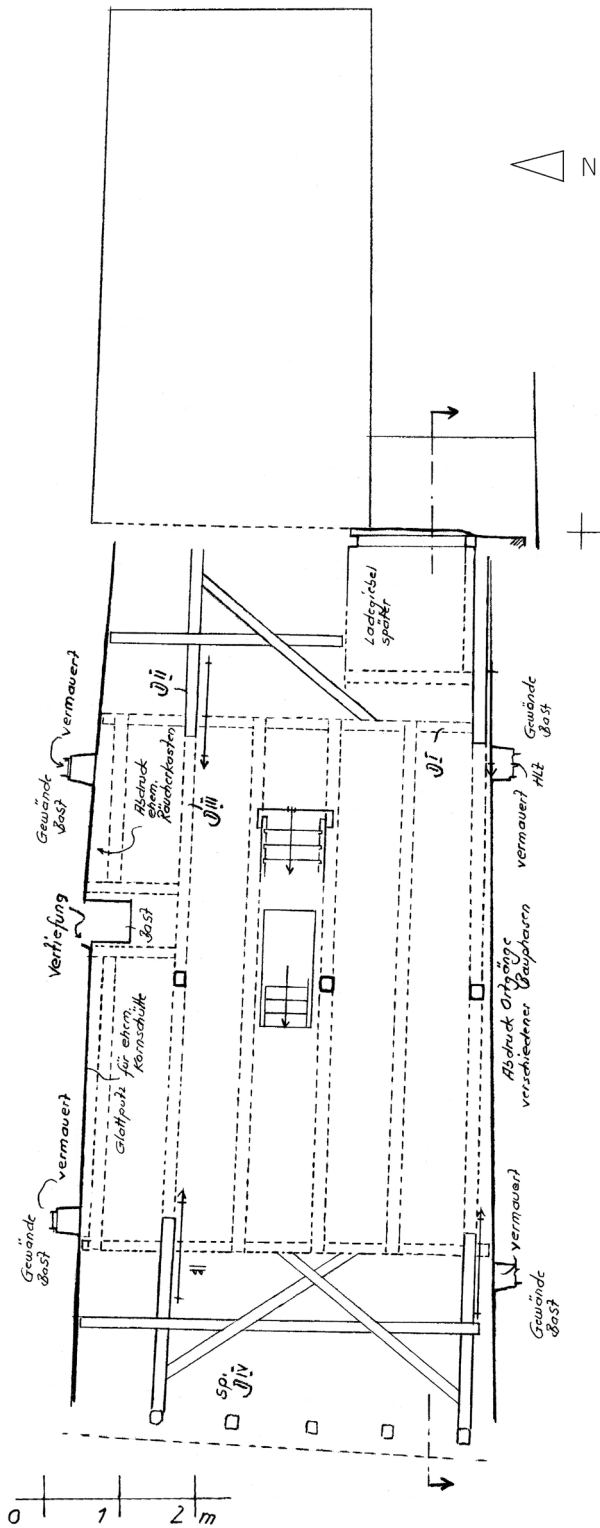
Adlegasse 3, Grundriss 1. Dachgeschoss.
